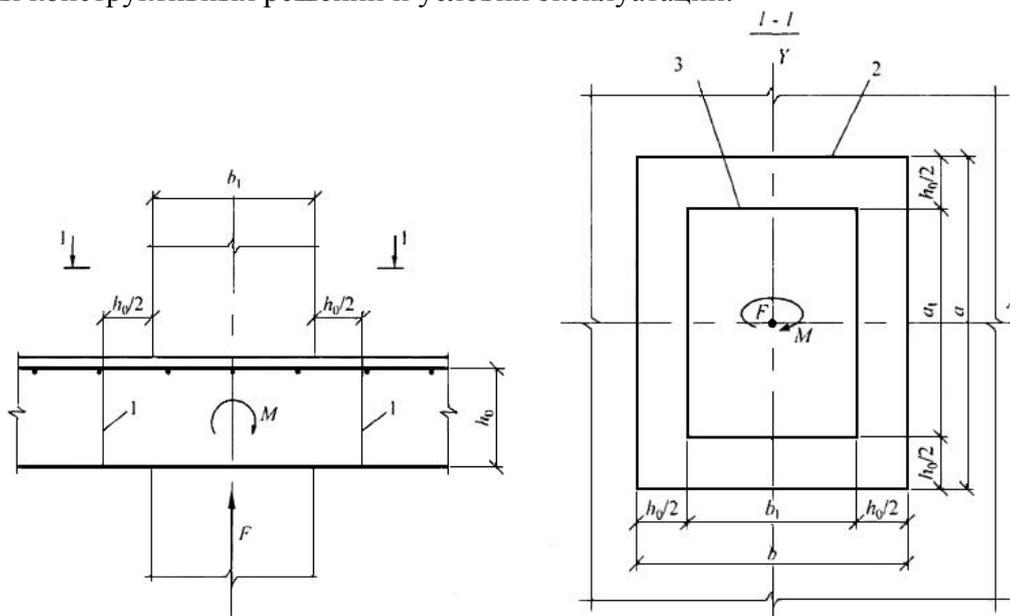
Схема расчёта на продавливание плит согласно СП 63.13330.2012: 1 – расчетное поперечное сечение; 2 – контур расчетного поперечного сечения; 3 – контур площадки приложения нагрузки
